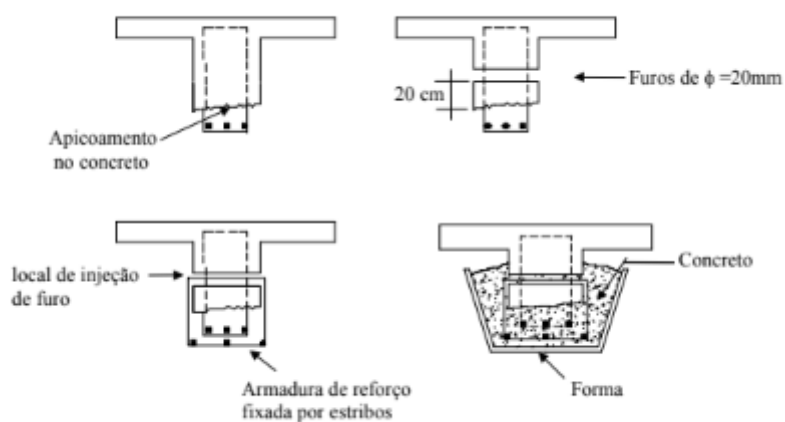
Reforço de viga por aumento de seção e novas armaduras longitudinais e transversais.
